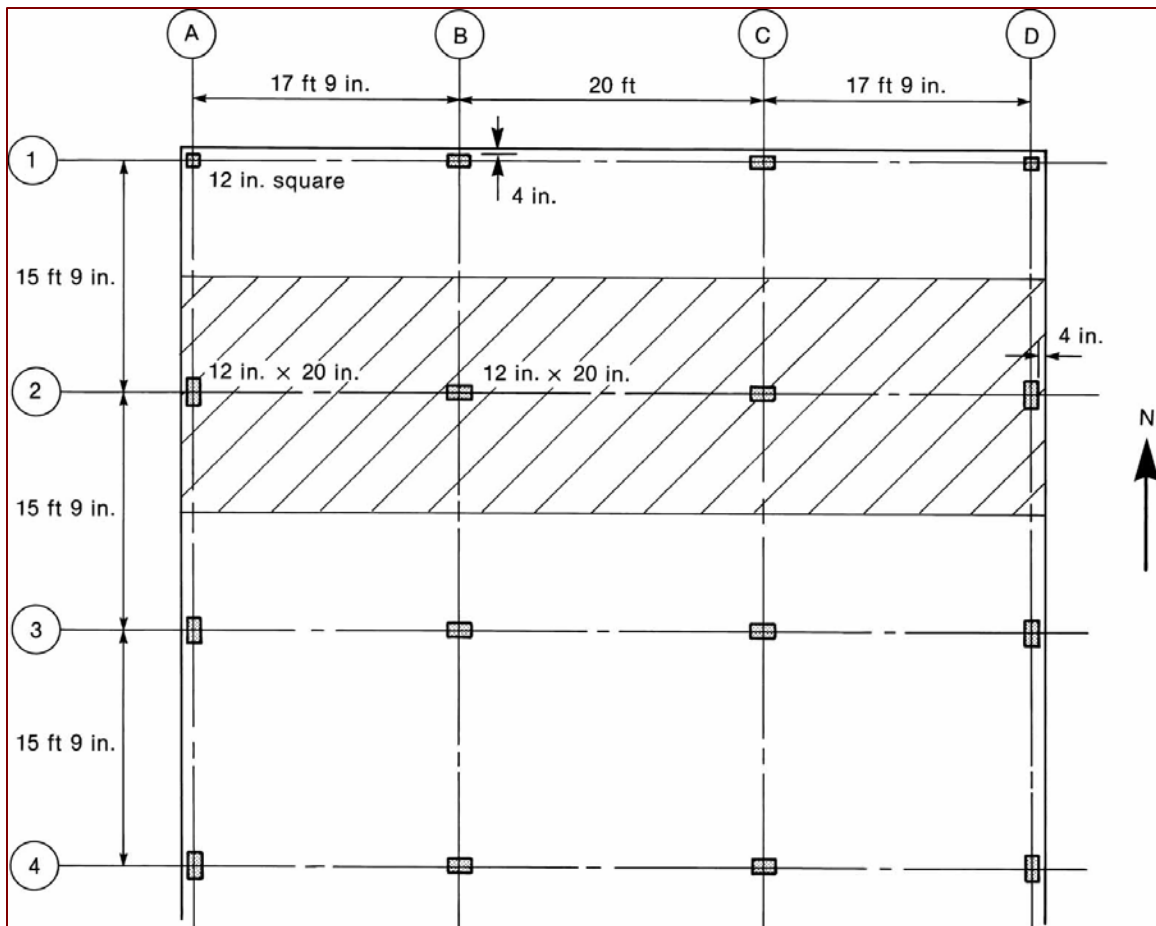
Planta de un entrespacio de placa plana—Ejemplos 10-5, 10-7, 10-9 y 10-10.
